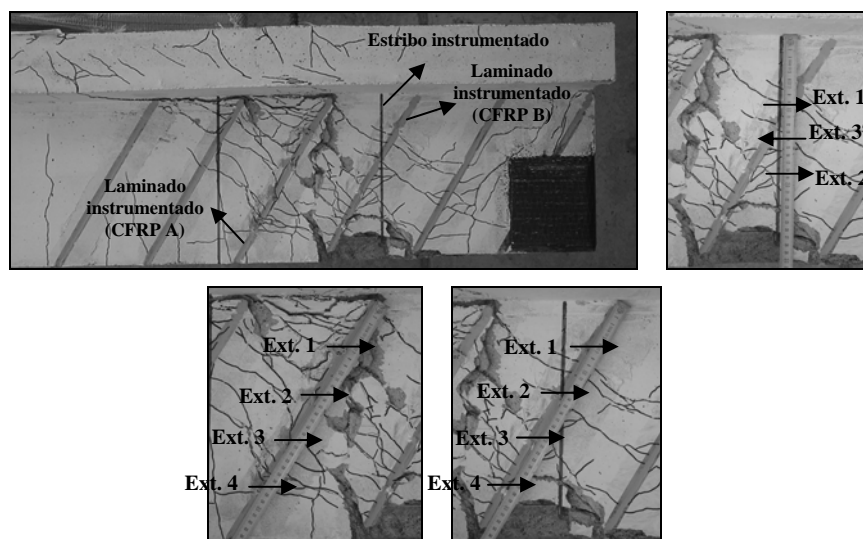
Localização dos extensómetros no laminado e estribo instrumentados da viga 2S-6LI60-B.
